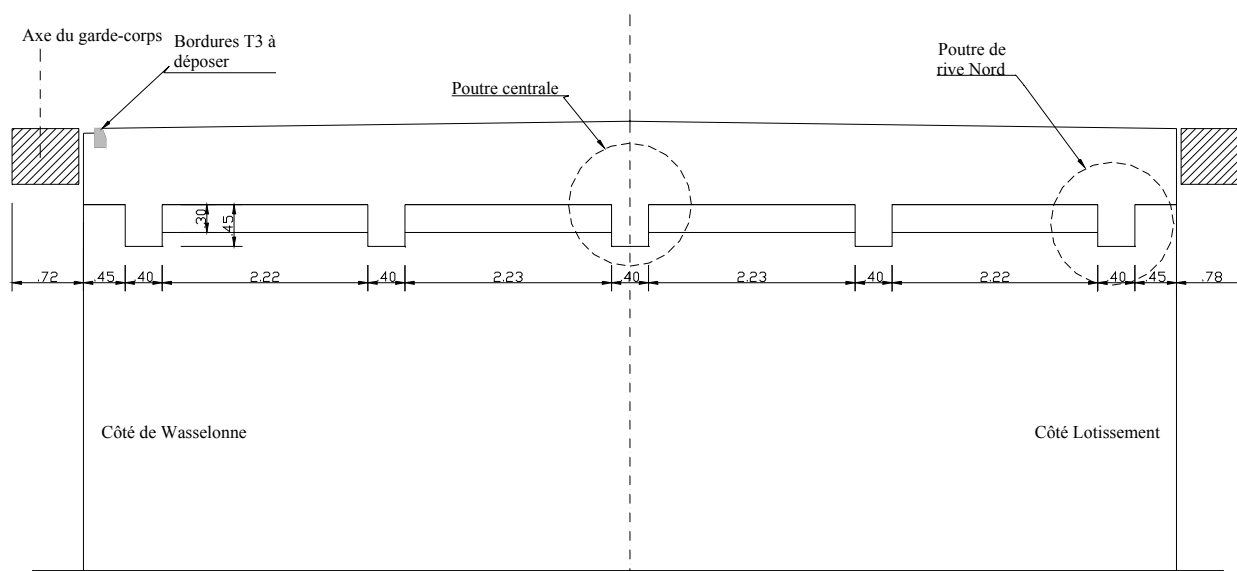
Coupe transversale du pont RN4 sur la rue de la Douane à Wasselonne – indication des poutres inspectées
